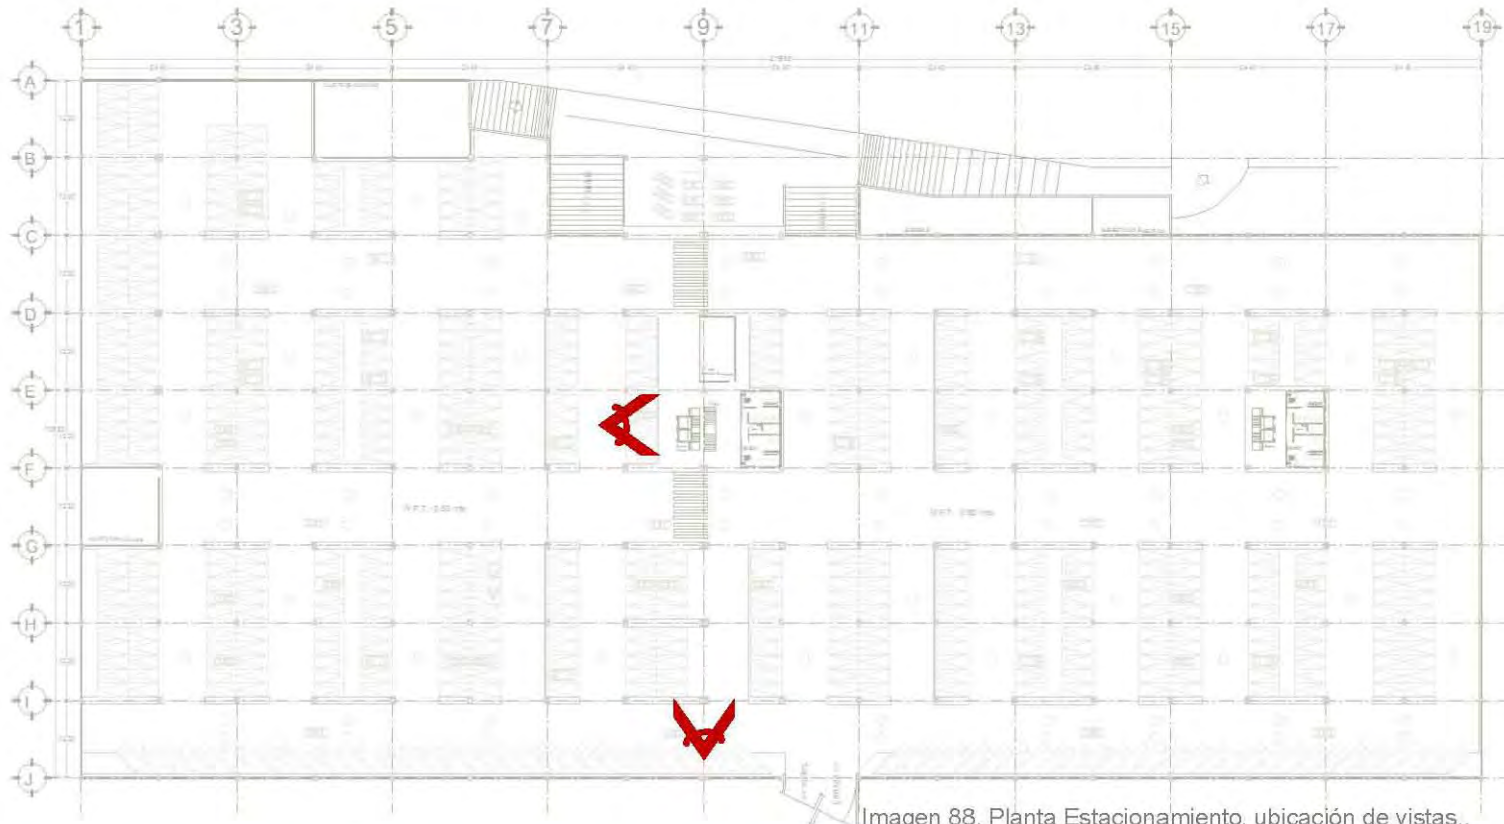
Planta Estacionamiento, ubicación de vistas..
